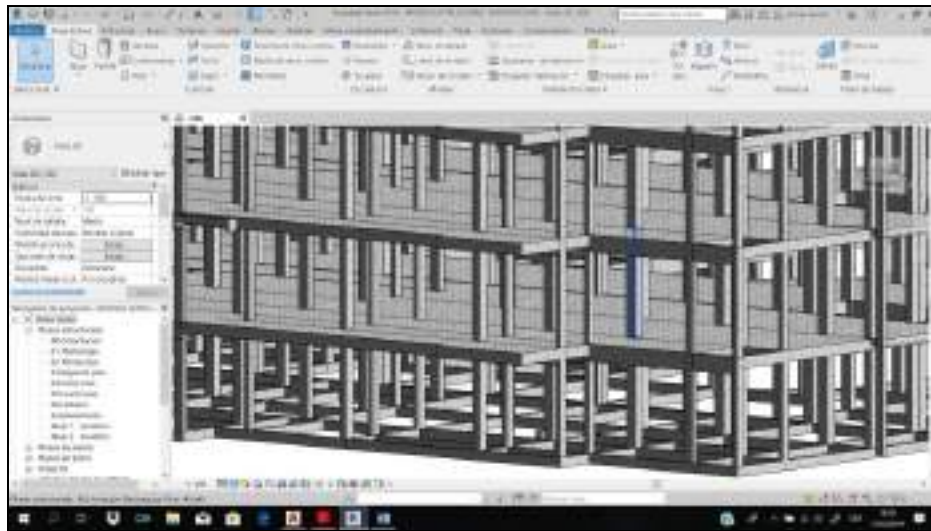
Autodesk Revit -Vista 3D Modelado estructural de Columnas, vigas y losas
